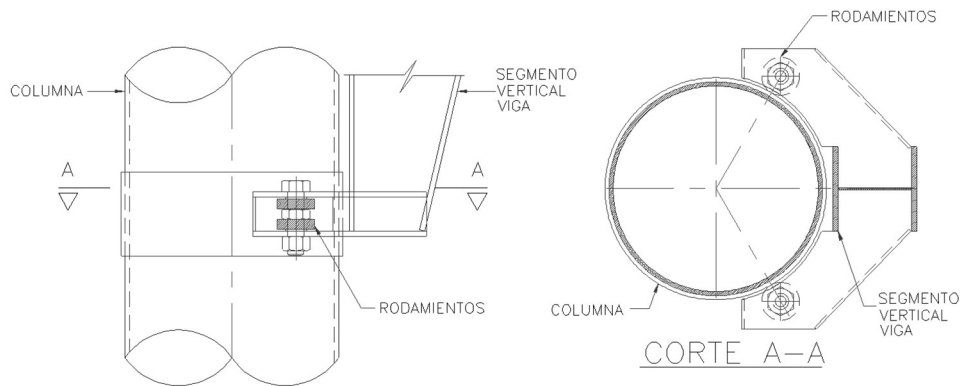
Apoyo de segmento vertical de viga sobre columna (archivo propio)
